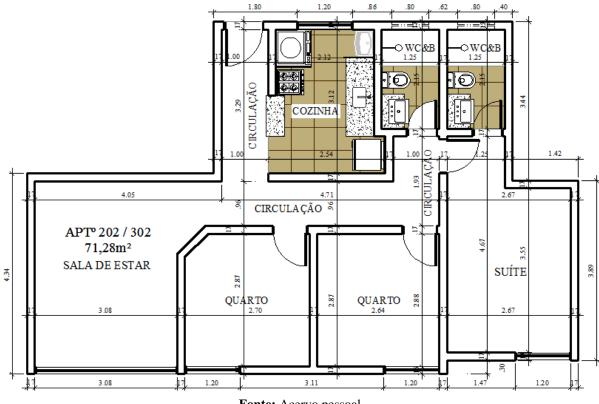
Planta Baixa de UHC de Tipologia 3 (Pavimento tipo)
